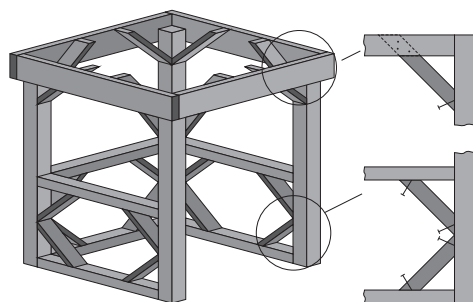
Укрепление стоек за счет привязки к элементам ограждения и кровли
